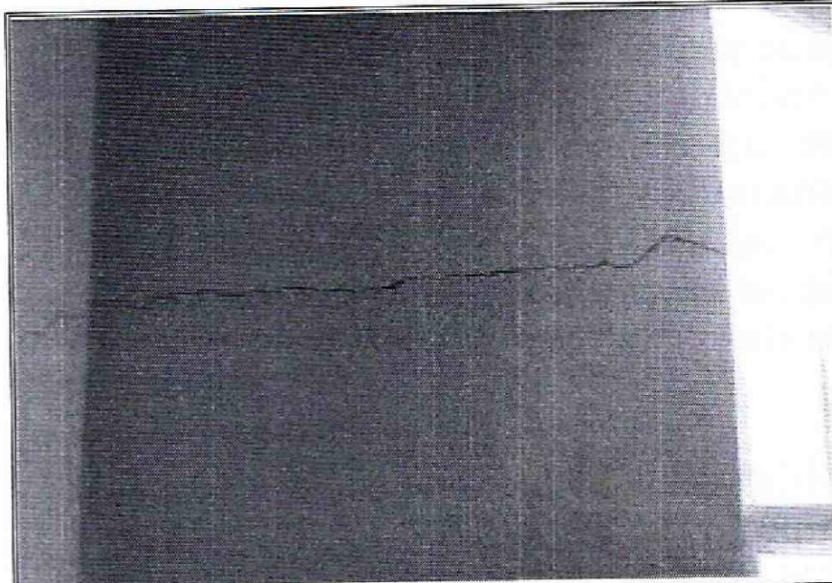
Fisuras tendencia diagonal muro divisorio predio de la Carrera 89 B No. 56 F - 53 Sur
